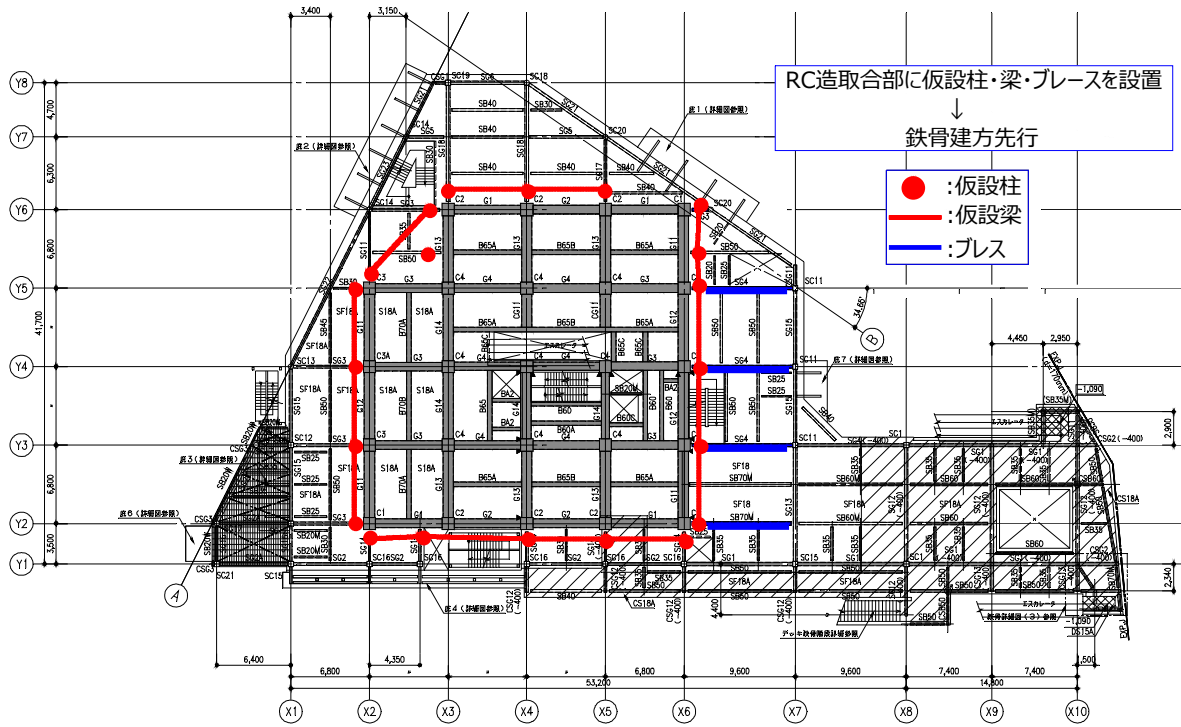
仮設柱・梁・ブレスの設置平面図(1階の場合)
